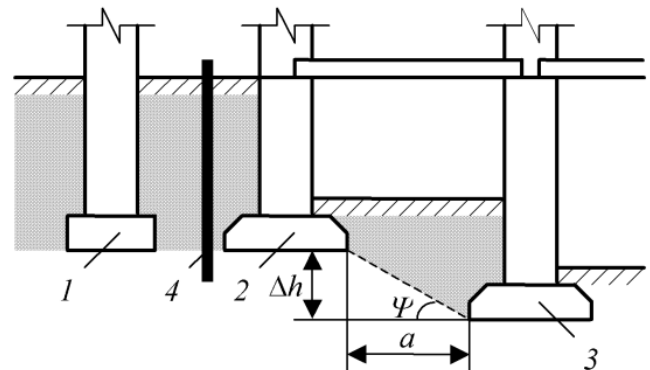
Схема захисту існуючої будівлі від додаткових осідань при зведенні поряд із нею нової будівлі з великою глибиною закладання фундаментів: 1 – фундамент існуючої будівлі; 2 – фундамент нової будівлі; 3 – фундамент із великою глибиною закладання; 4 – шпунтова стінка
